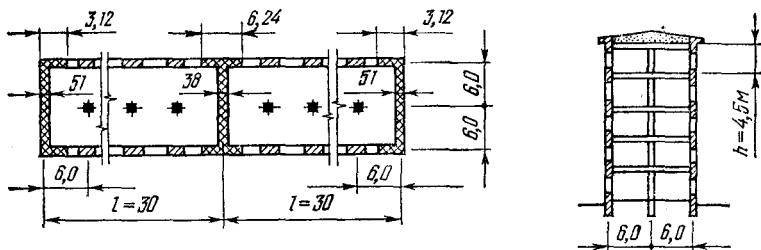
План и разрез пятиэтажного здания с тремя поперечными стенами.
